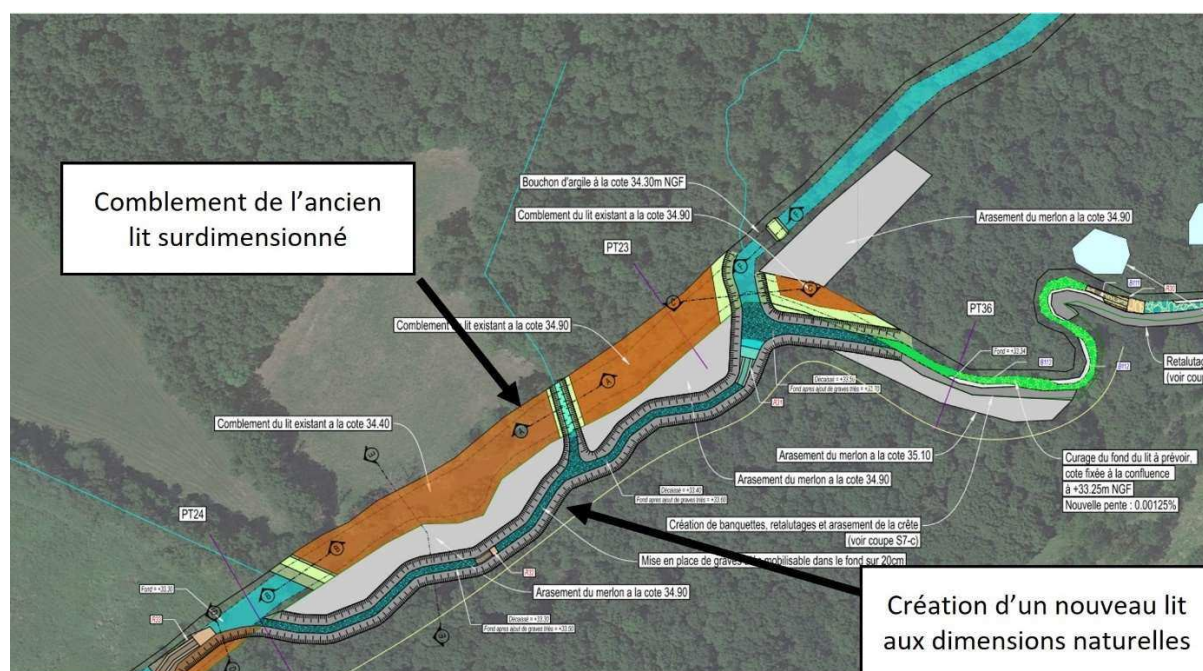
vue générale des travaux de reméandrage du Lathan au lieu-dit « Pont des Planches
